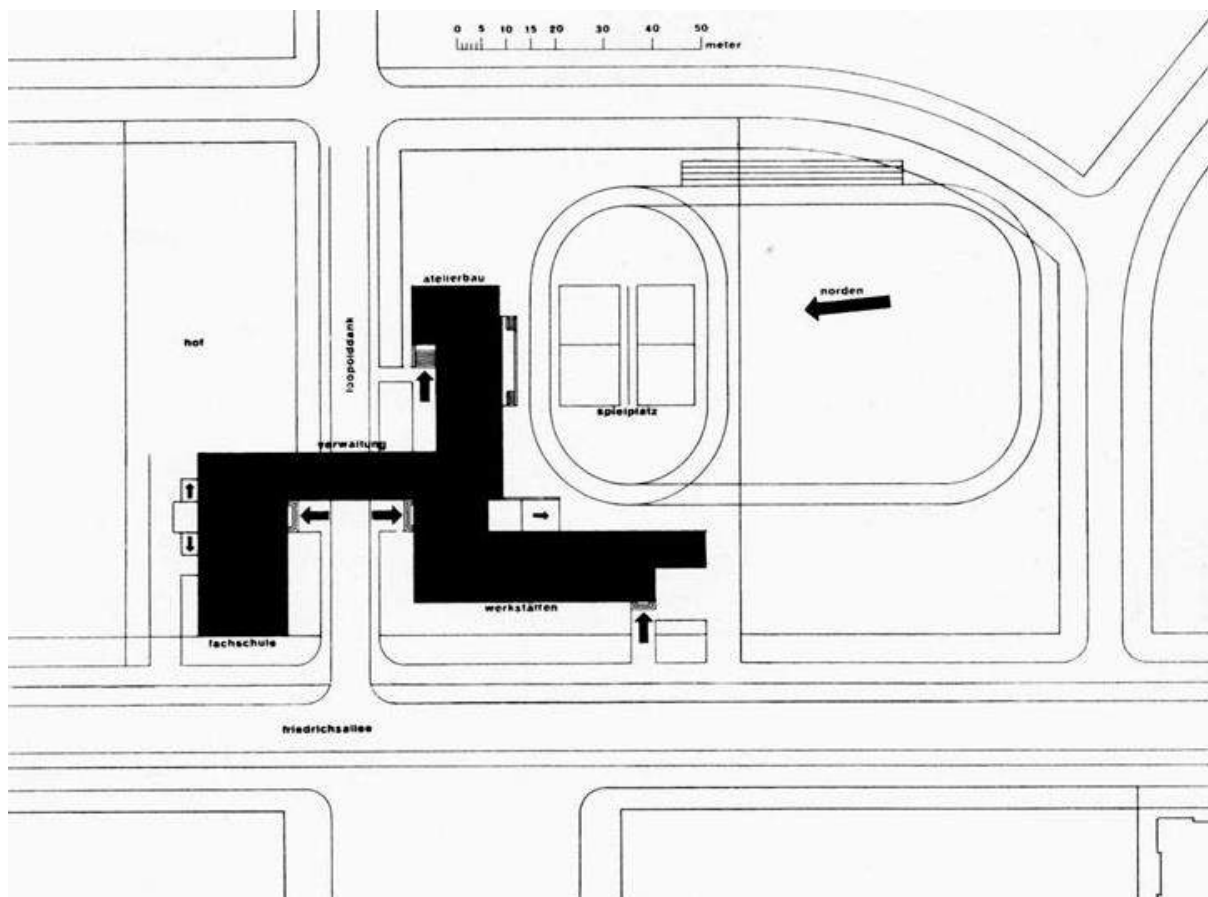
Lageplan der Anlage des Bauhauses in Dessau
